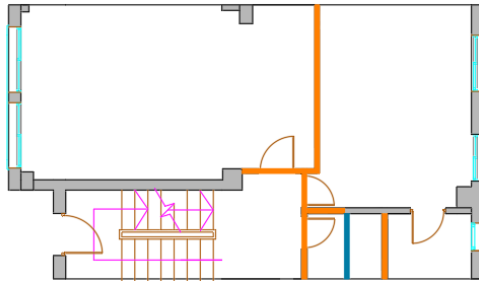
plano de demoliciones planta baja. Fuente propia
